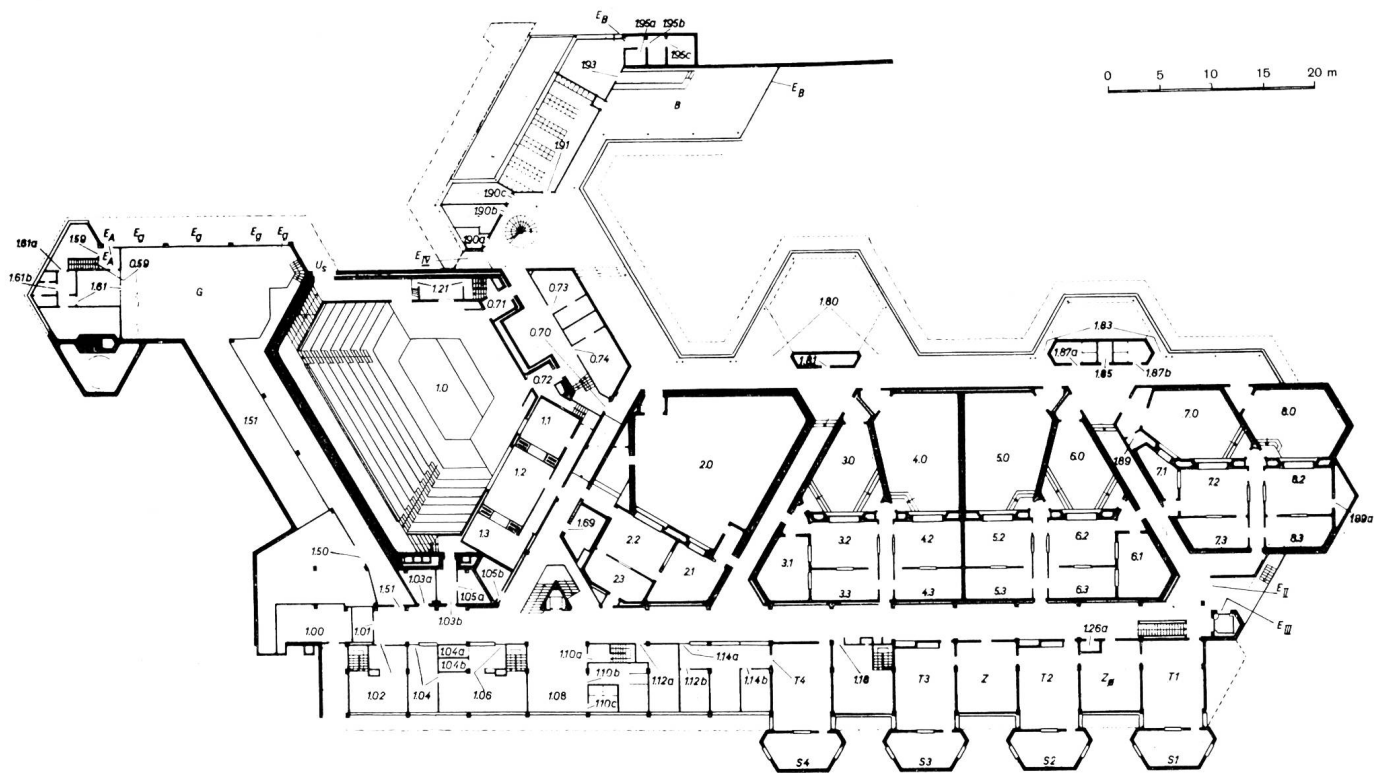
Grundriss des ersten, sog. technischen Stockwerkes – Pianta del primo piano, detto «piano tecnico»
